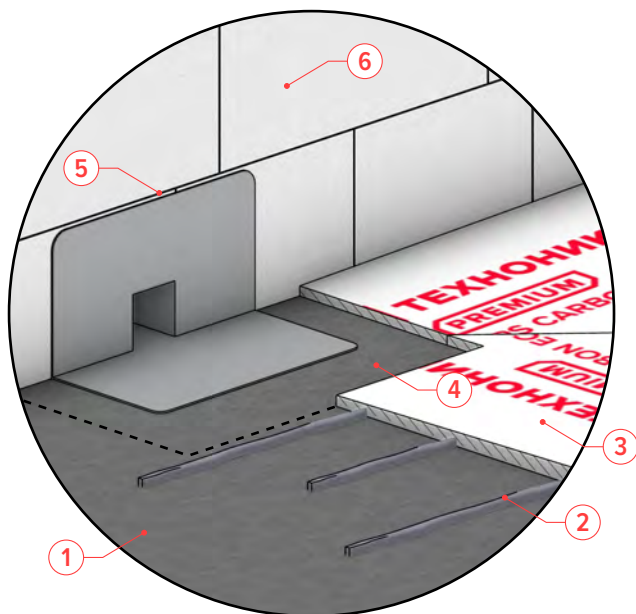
Разрез плоской железобетонной крыши с уклонообразующим слоем из клиновидной теплоизоляции
